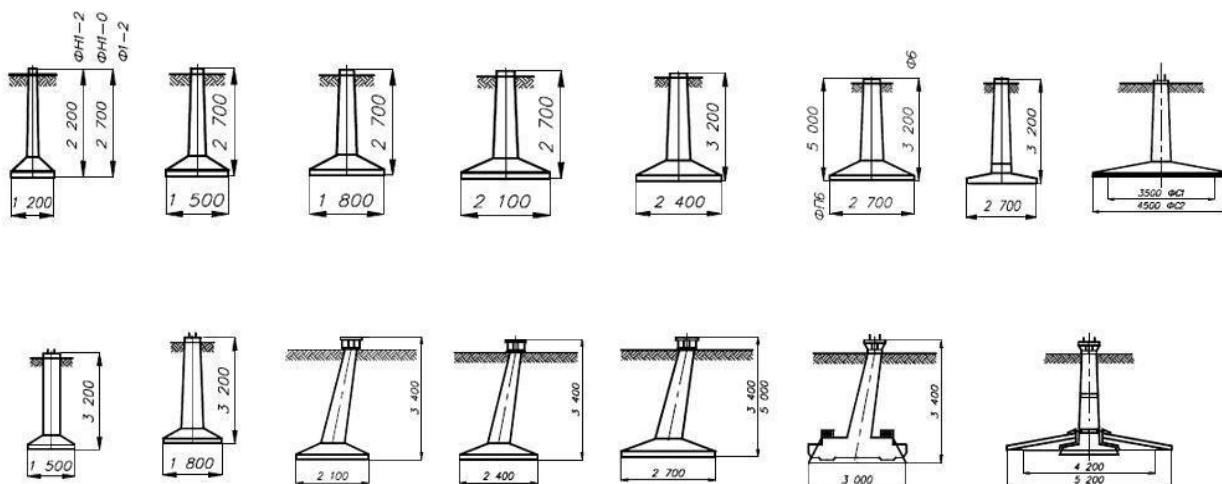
Грибоподібні залізобетонні фундаменти для опор ПЛ 35-500 кВ
